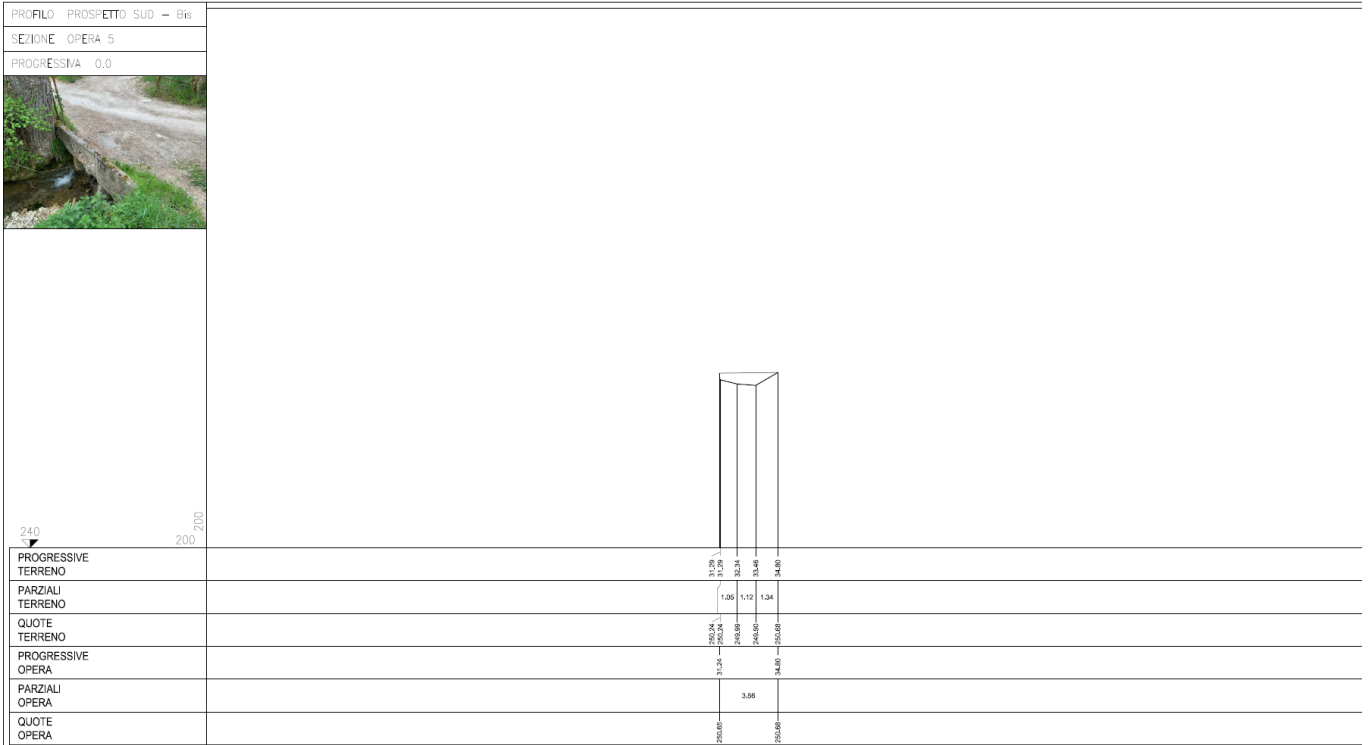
S4 – Profilo scolo idraulico Prospetto sud
